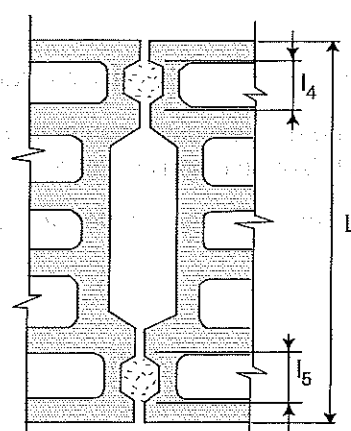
Coupe horizontale. Hourdage des joints verticaux de blocs (d'après DTU 20.11)¹⁾.
